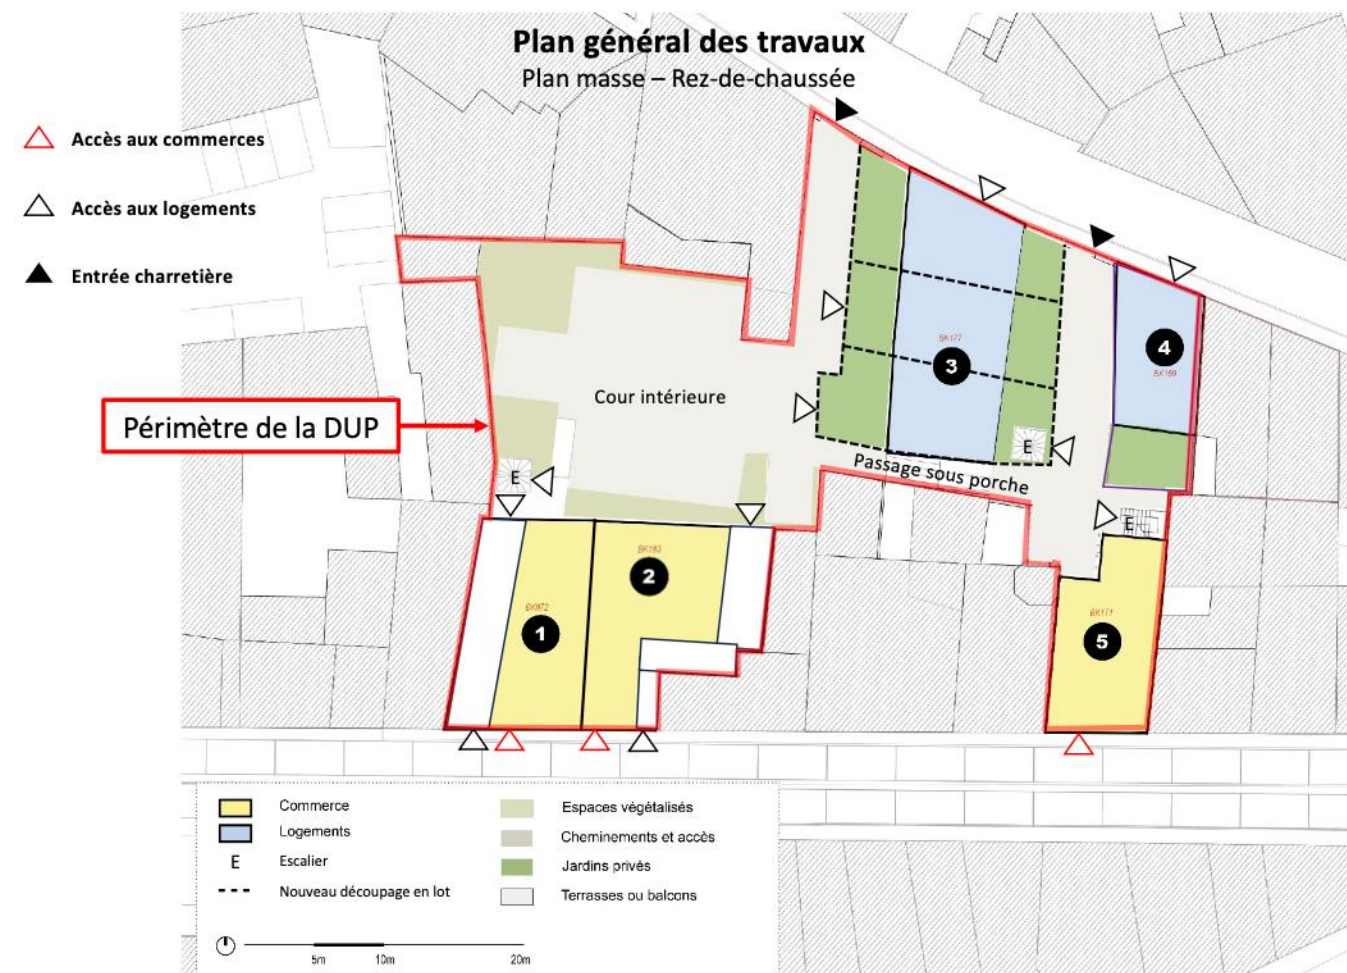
Plan masse – Rez-de-chaussée du projet retenu
